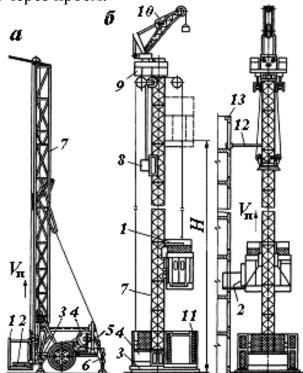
Мачтовые строительные подъемники: a – грузовой; δ – грузопассажирский
